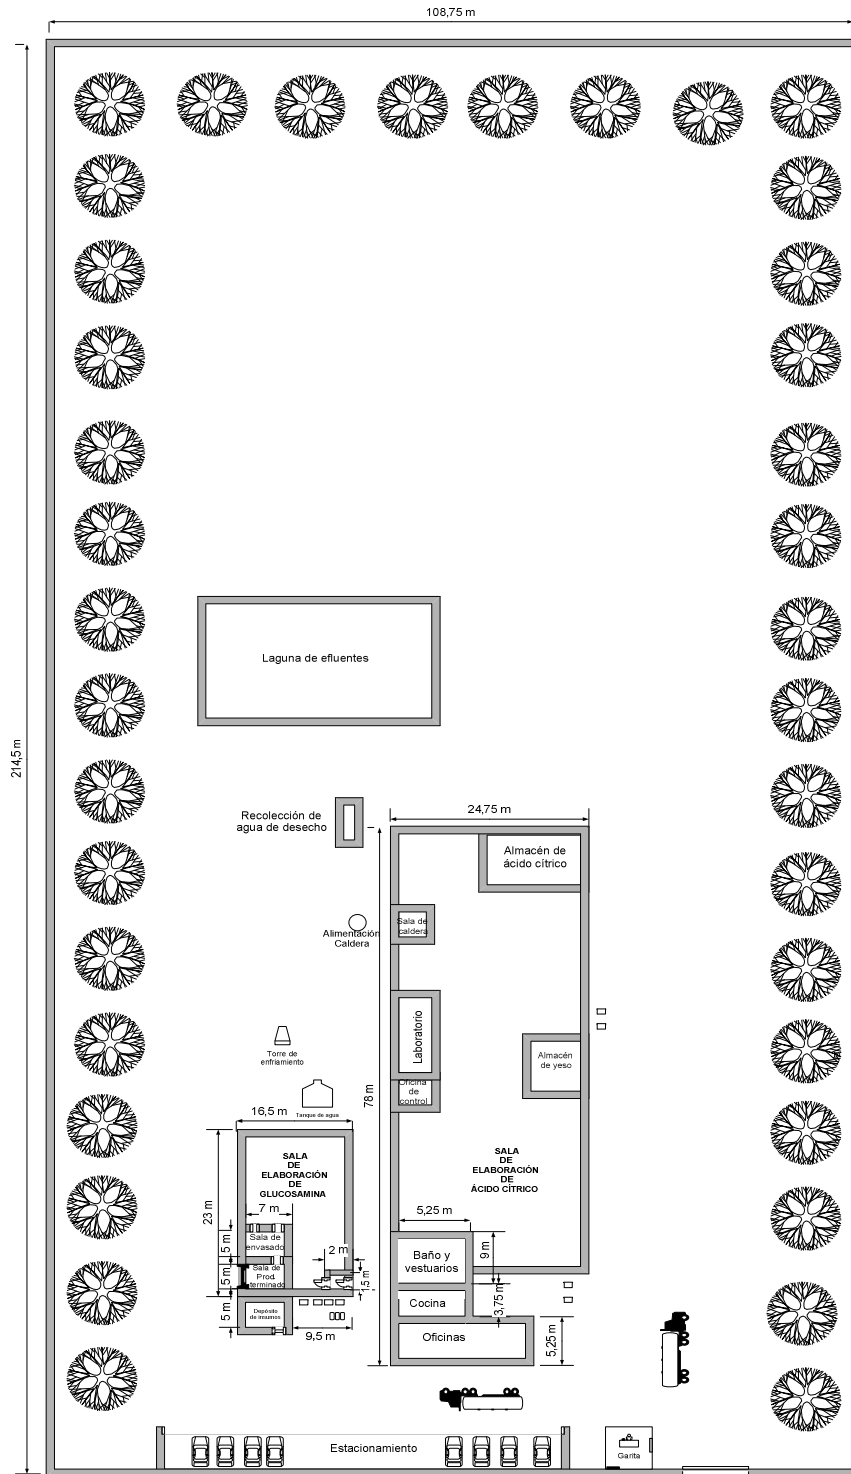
Plano de la planta de clorhidrato de glucosamina emplazada en el predio de la planta de ácido cítrico.
